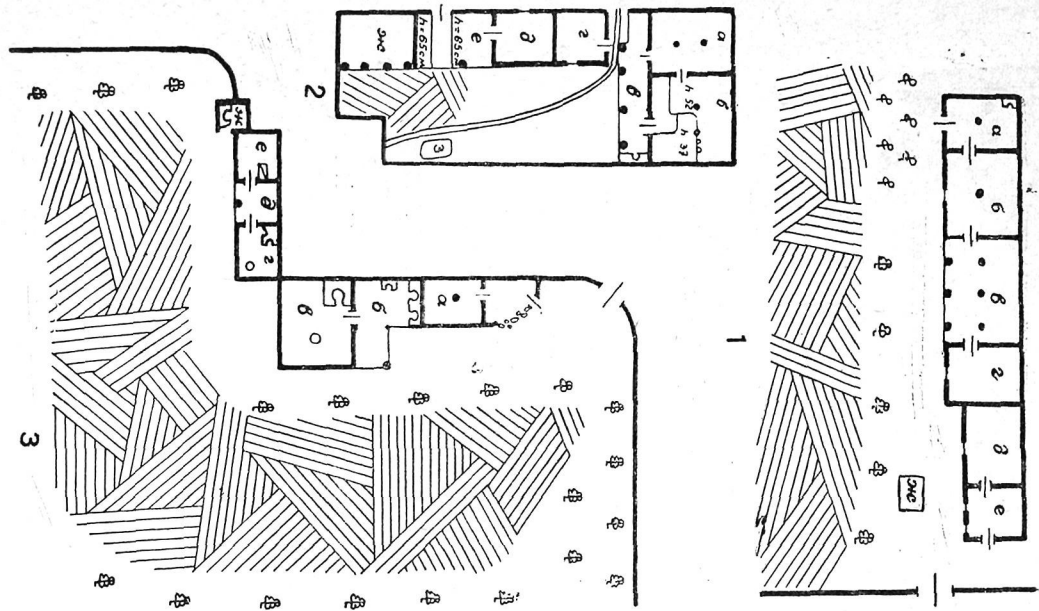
Схемы планов усадеб: 1—усадьба Сокиева Хушмамада, к. Навди, дом построен в 1938 г.: а—кухня—аловхона, б—жилая комната — хона, в—открытая веранда — долон, г—кладовая — хичра, д—мехмонхона, е—передняя — дахлез, ж—деревянная кровать — кат; 2—усадьба Гиёева Сайфулдинна, к. Яхч, дом построен в 80-х годах XIX в.: а и г—хичра, б—хона, в—долон, д—мехмонхона, е—вход в мехмонхону, с площадками по бокам прохода, ж—конюшня — рузохури асп; з—суфа; 3—усадьба усто Худойдода, к. Нушори-Поён: а—хлев, б—долон, в—жилая комната старшей пары, г—жилая комната младшей пары, д—веранда, е—жилая комната, чистая, с железной печью, ж — помещенне для скота.
